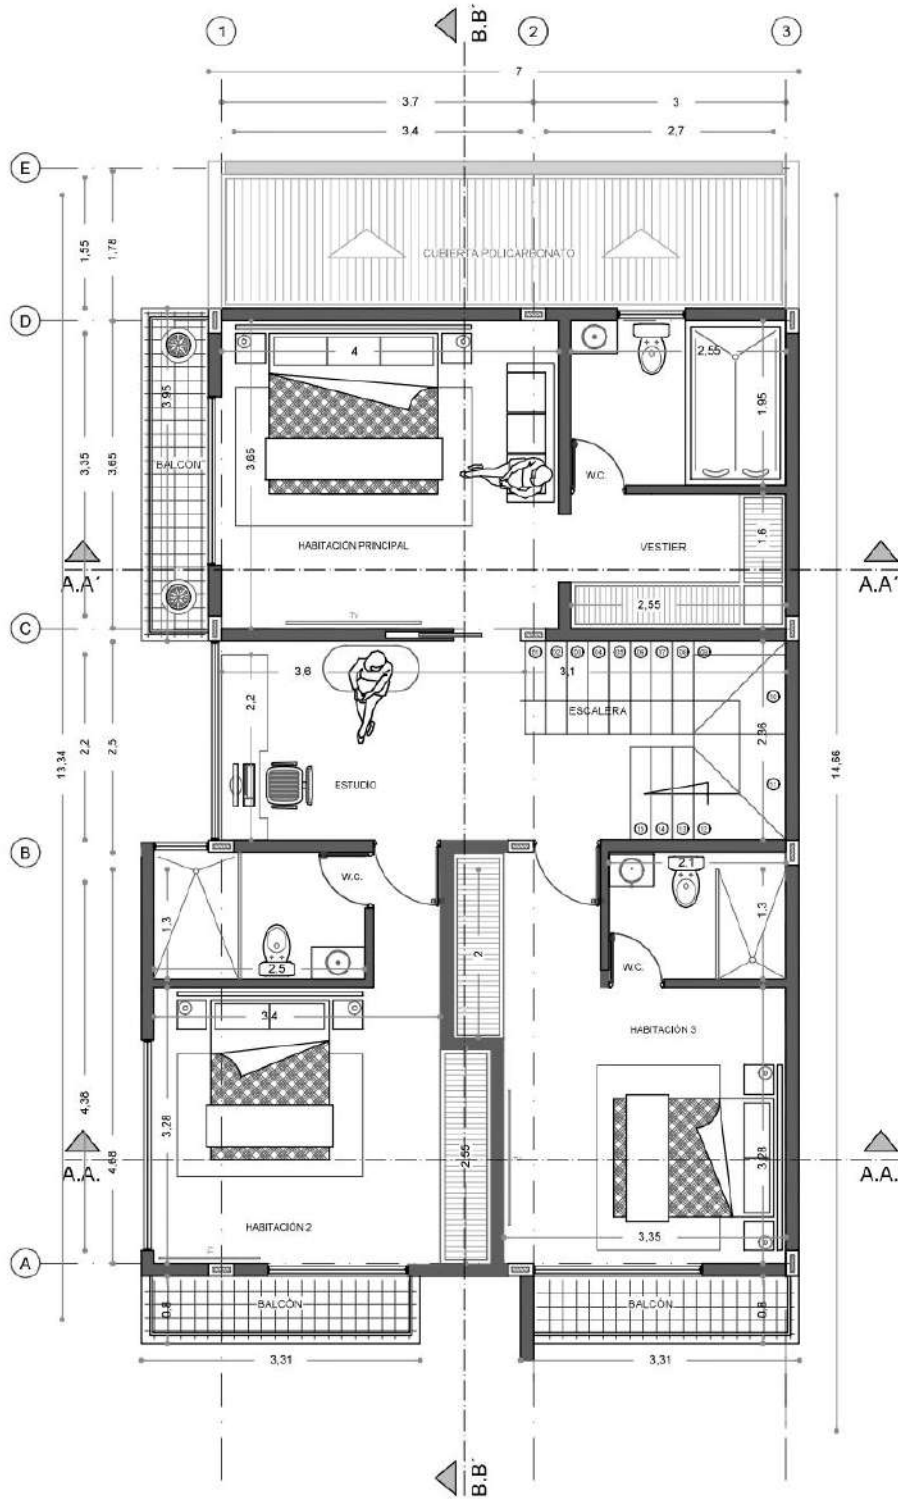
Planta segundo piso casa San Sebastián; Fuente: Constructora Pérez
